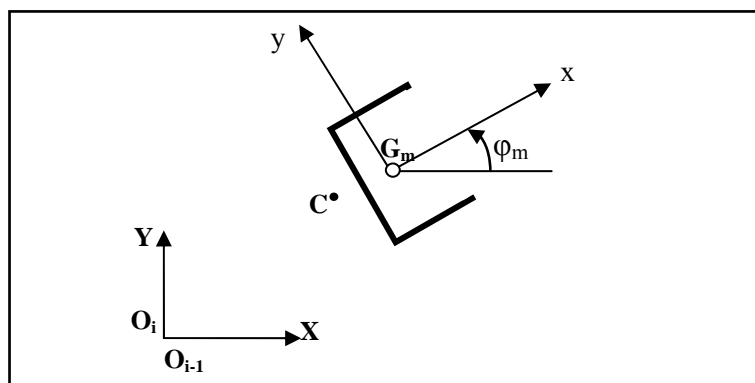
Elemento del Muro Estructural entre los Diafragmas $i-1$ e i .
